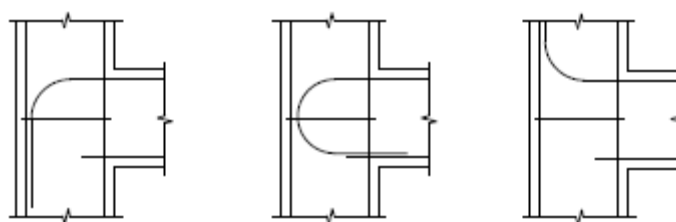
Pormenorização da armadura das ligações viga-pilar (Taylor, 1974)
